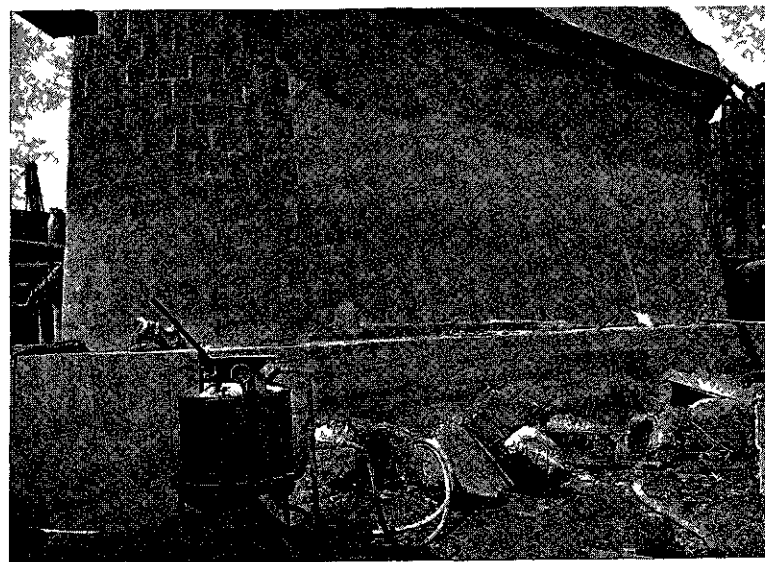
Face rive droite apres confection de la ceinture en beton arme , on voit les trois tubes noyes dans cette ceinture et qui seront utilises pour les injections
